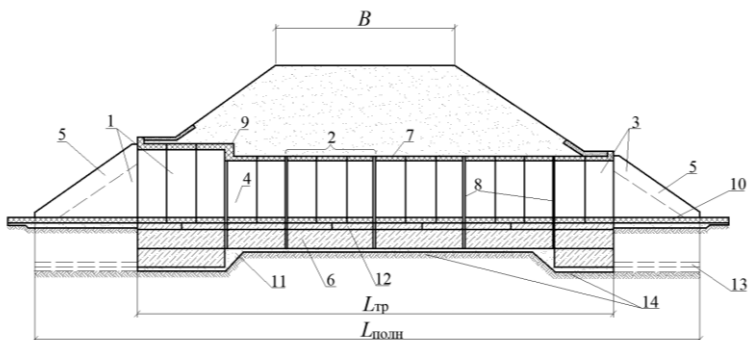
Схема прямоугольной железобетонной водопропускной трубы:
